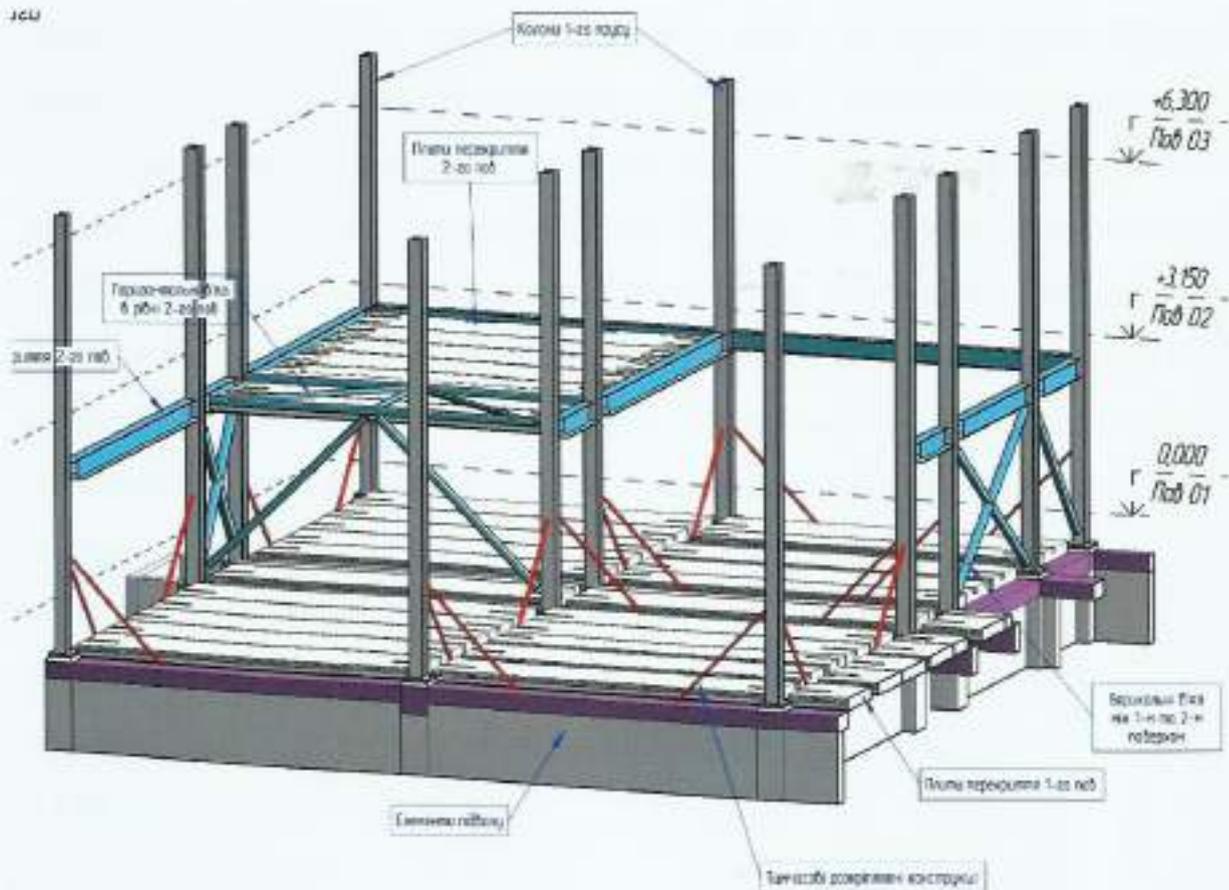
Принципова схема розташування основних конструктивних елементів житлового будинку зі сталевим каркасом та збірними залізобетонними міжповерховими перекриттями [25]
